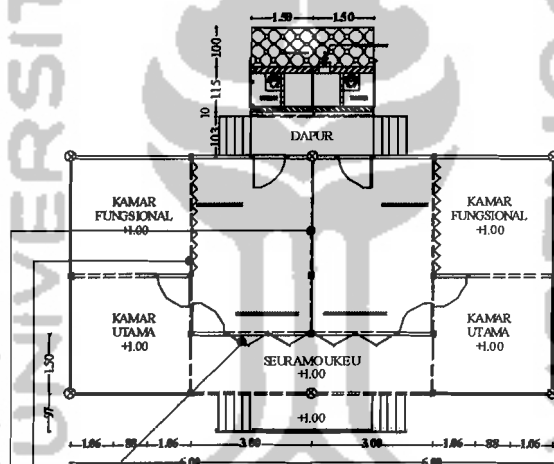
Denah Barak dan Ruang Usaha LT 1
